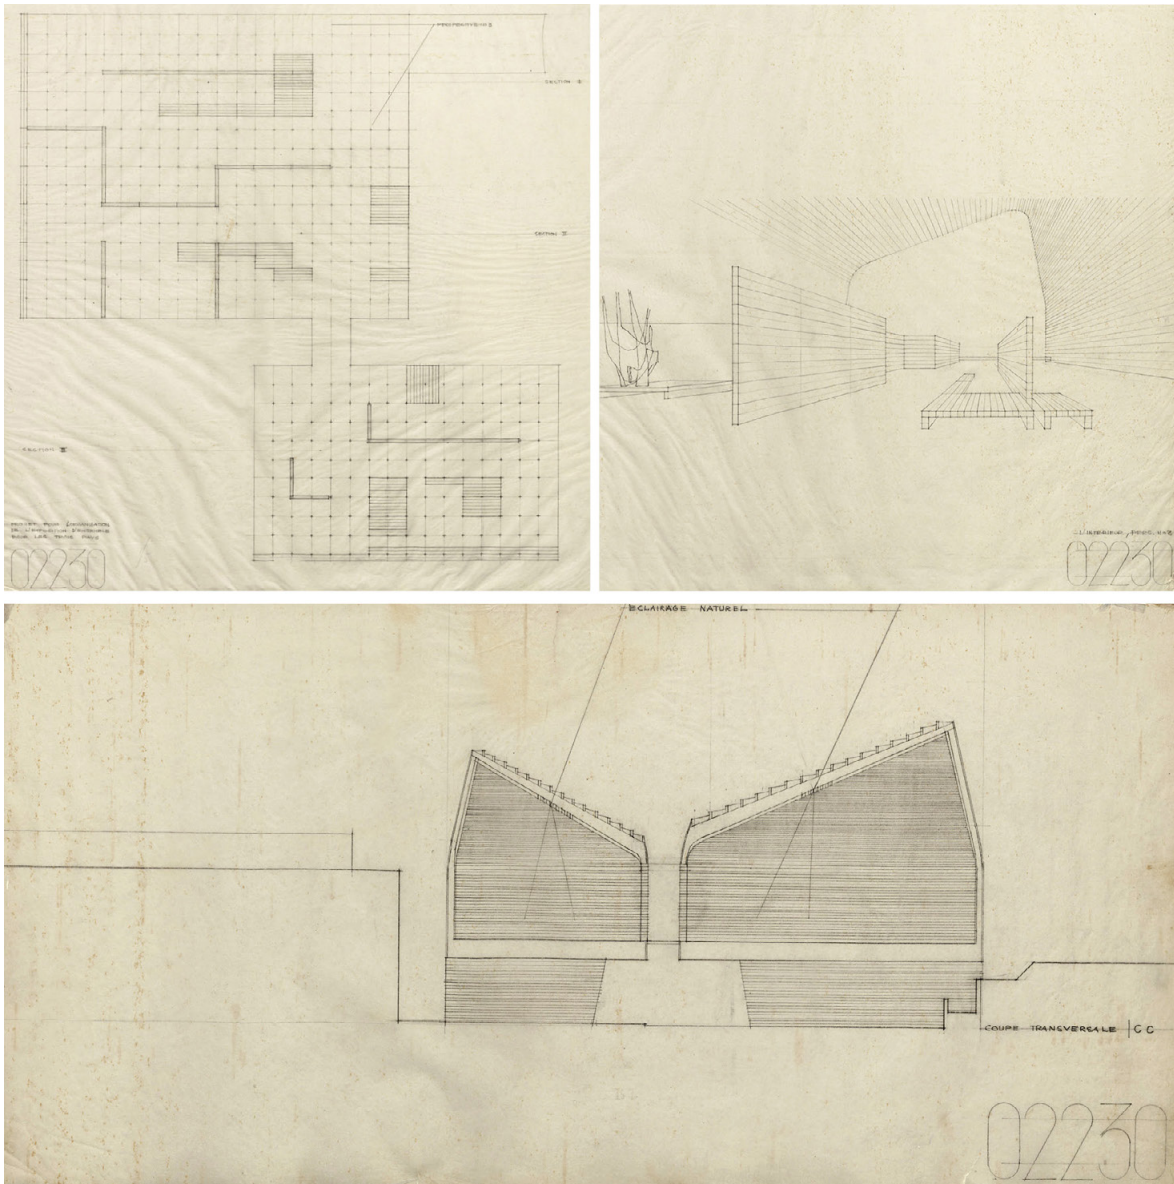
Planta superior, sección y vista exterior desde la cota de acceso de la propuesta 10. 1958, Reima Pietilä.
